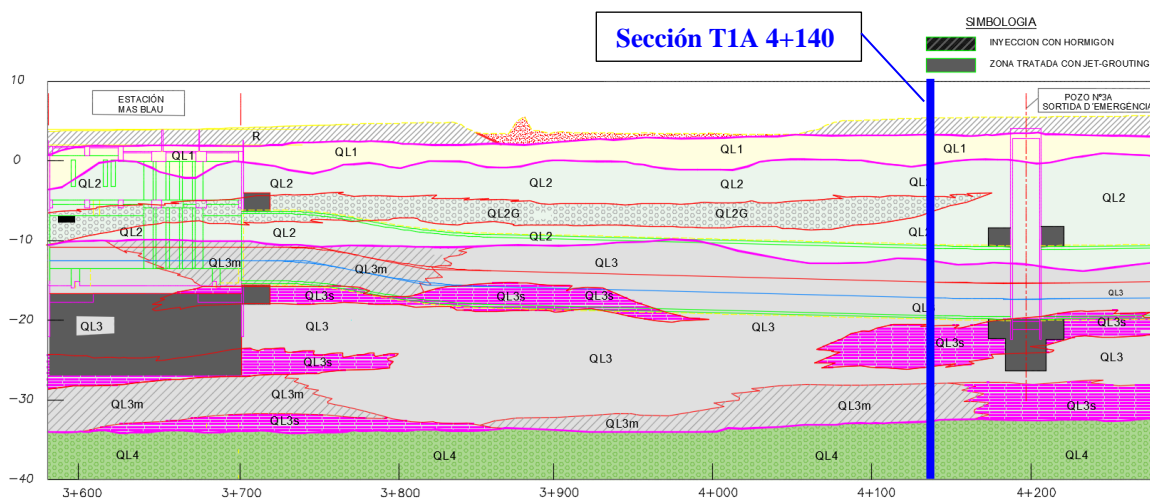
30. Perfil geológico de la sección de control T1A PK 4+140 y la instrumentación colocada en el terreno
